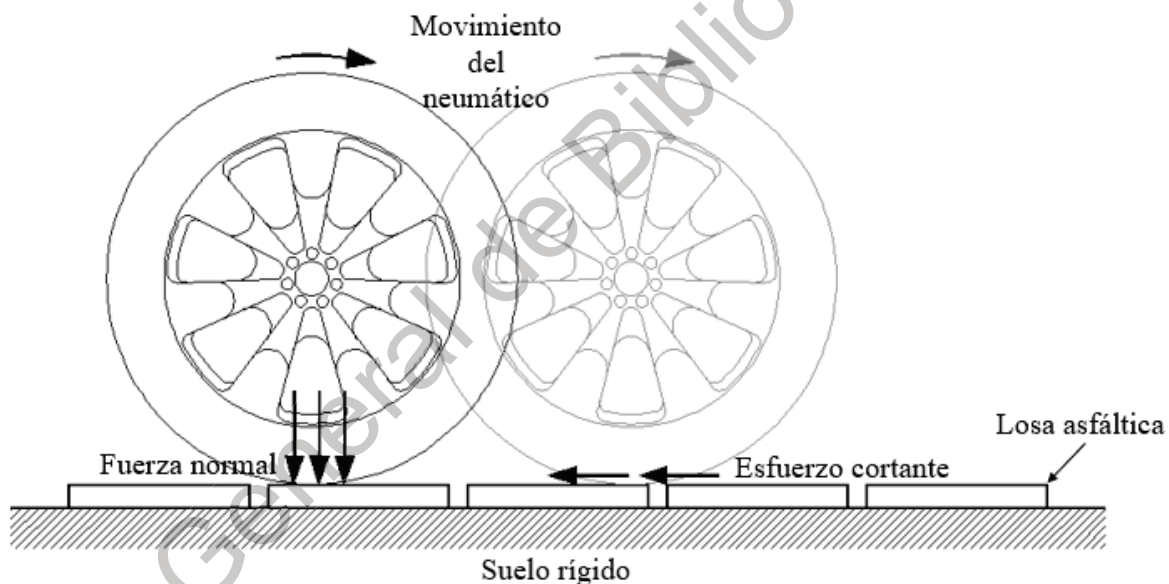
Modelo comprendido por elementos desacoplados en un pavimento asfáltico.
